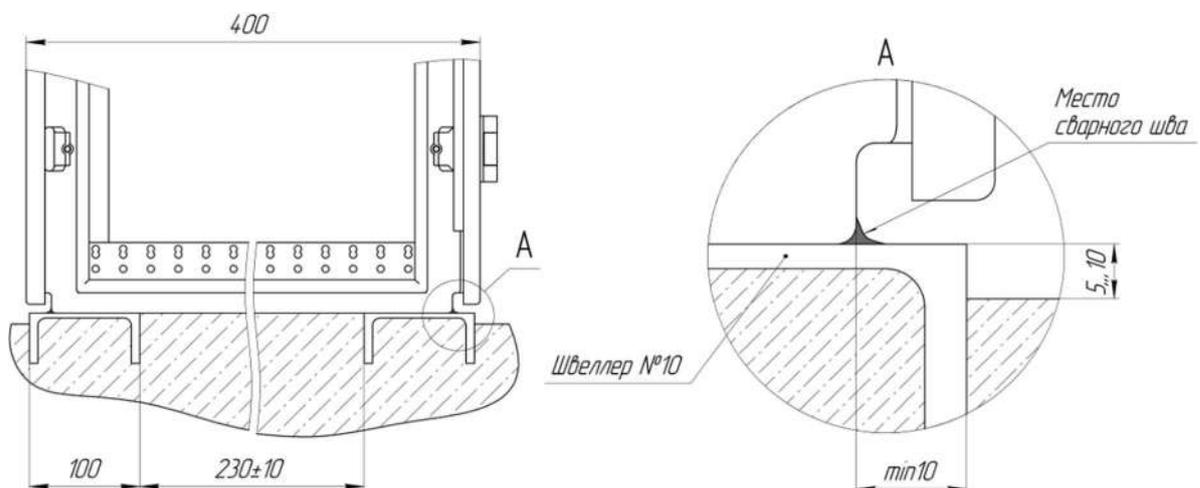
Крепление ПР2020 при помощи сварки
